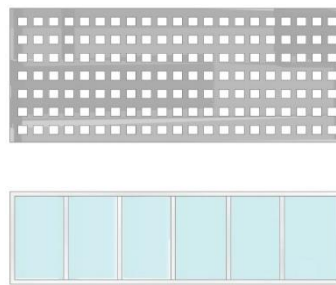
Cerramientos metálicos y vidrio, fuente: propia
